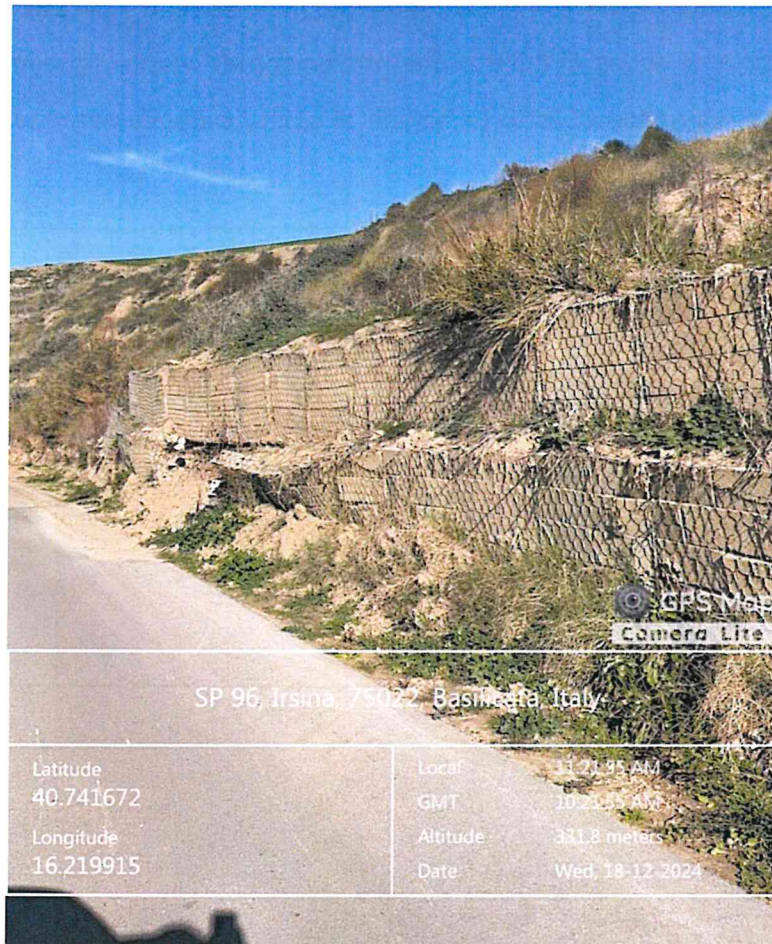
Impermeabilizzazione cunetta S.P. 96 al km 15
